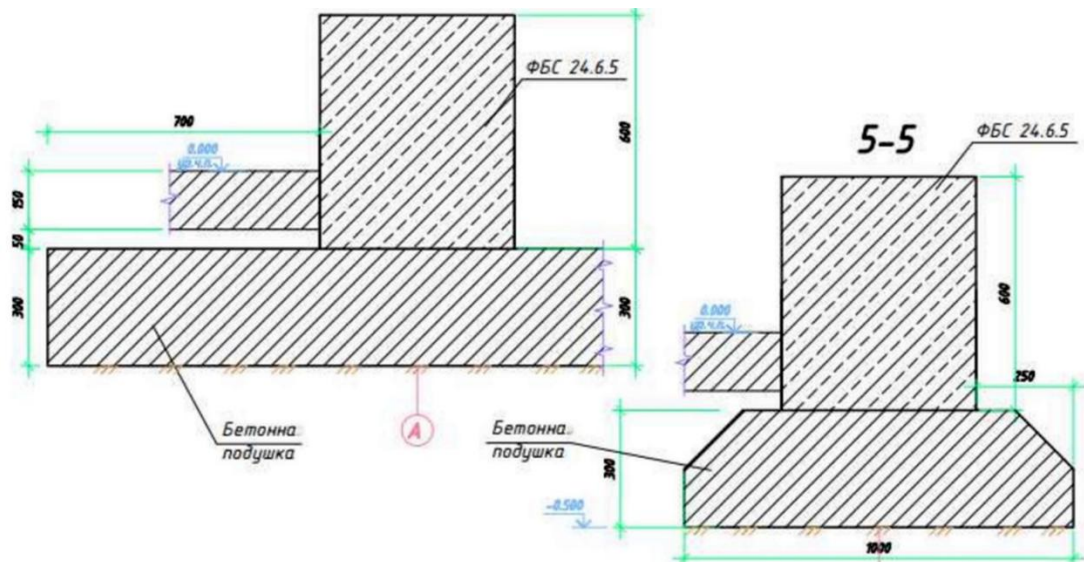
Розрізи 5-5, 6-6 по існуючих фундаментах
